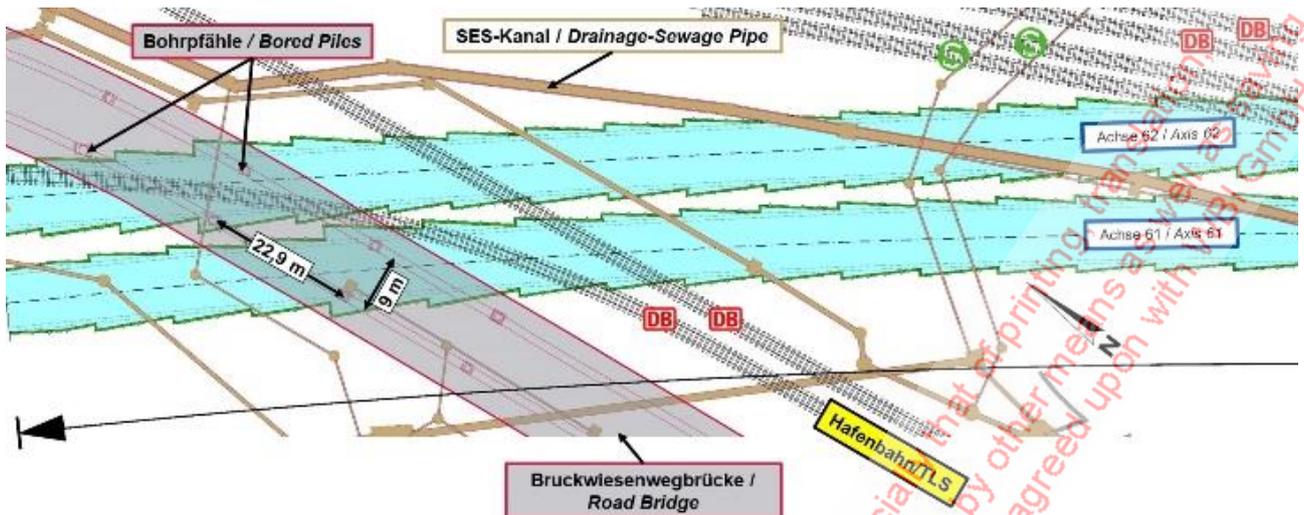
Unterfahrung Bruckwiesenwegbrücke und DB-Strecke, Lageplan, Teil Nord
